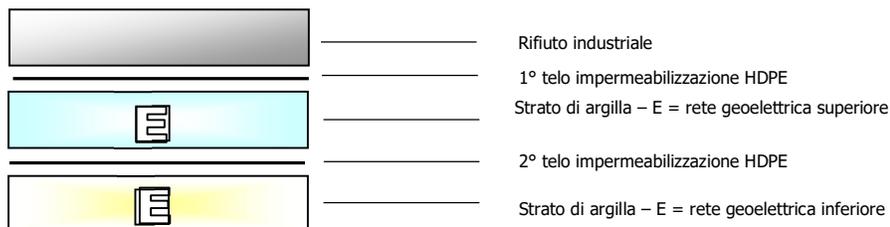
Schema grafico dell'impermeabilizzazione dell'impianto
